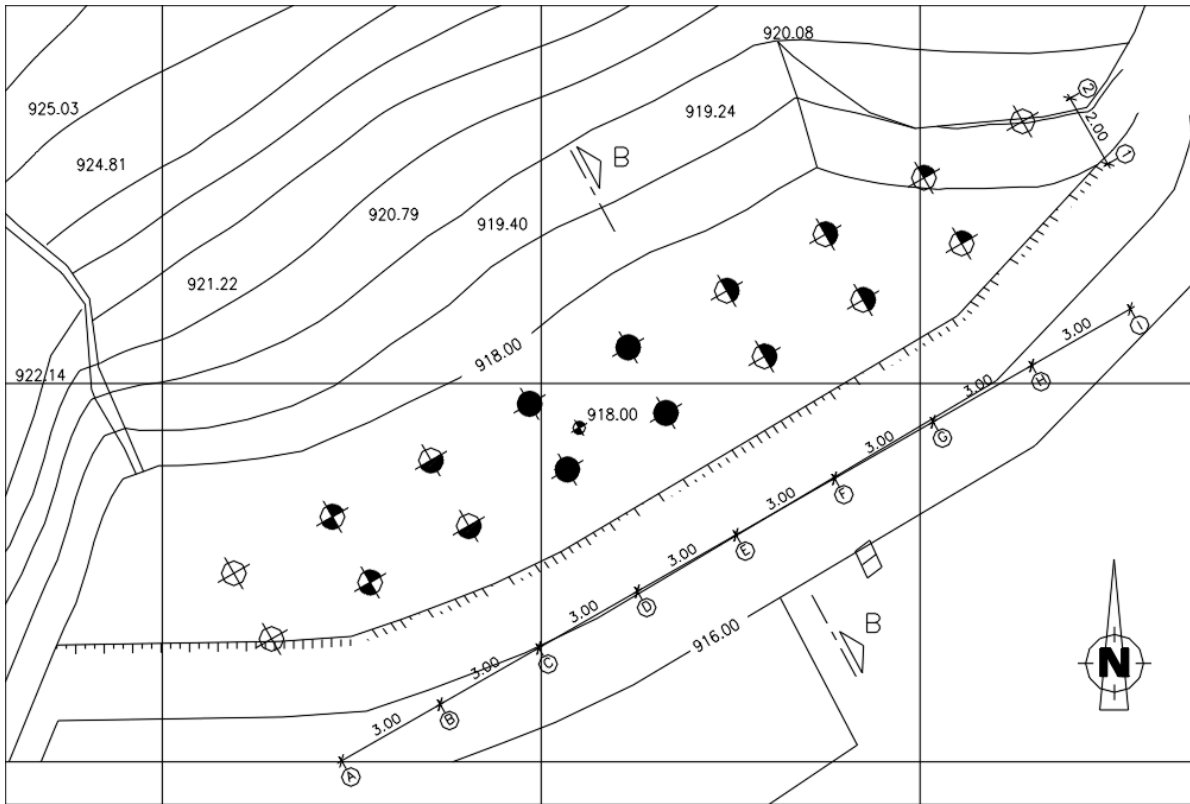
Sitio de construcción del muro, mostrando ubicación de los pilotes.
